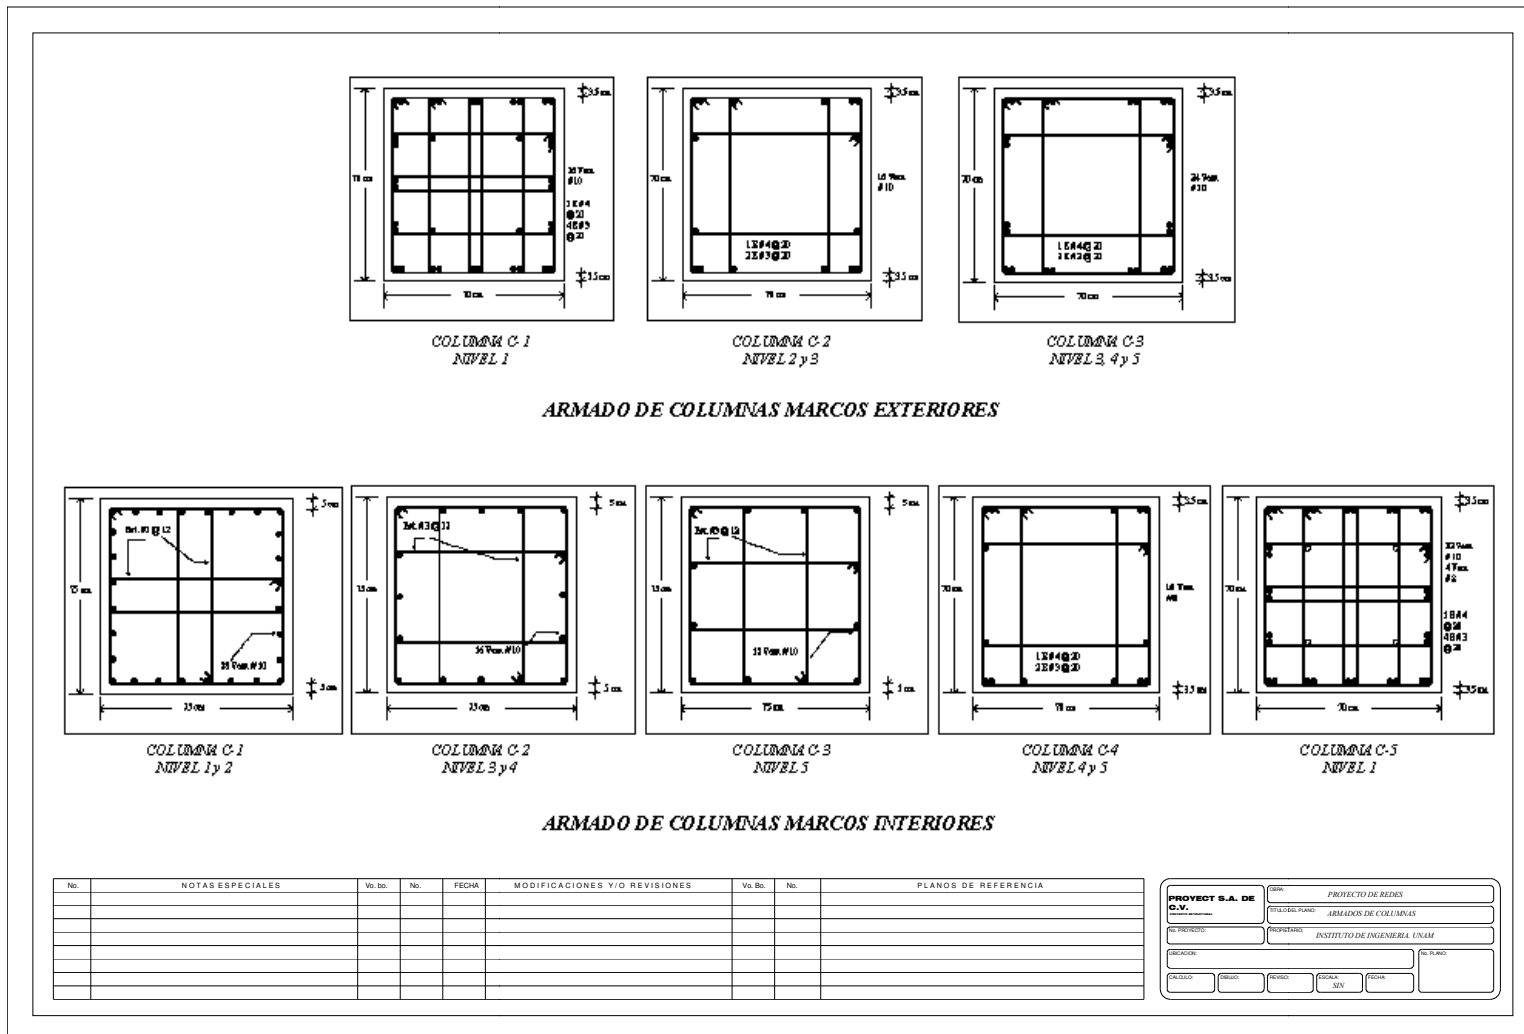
Secciones estructurales del edificio de 5 niveles
